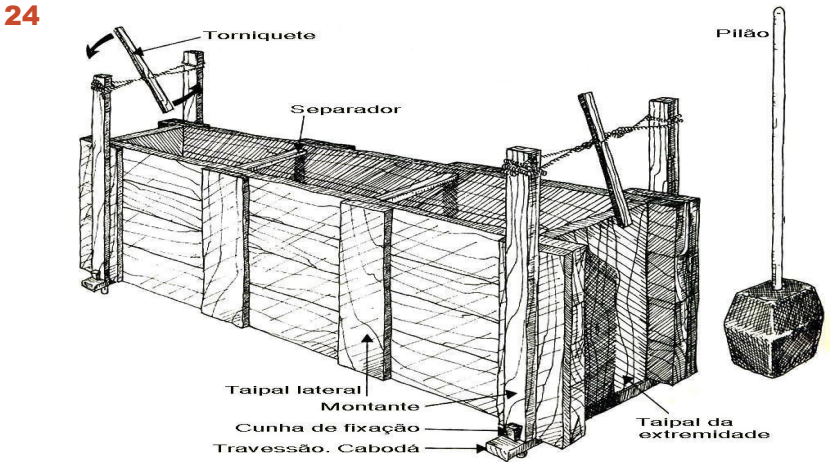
Detalhe das ferramentas para execução da taipa de pilão.
